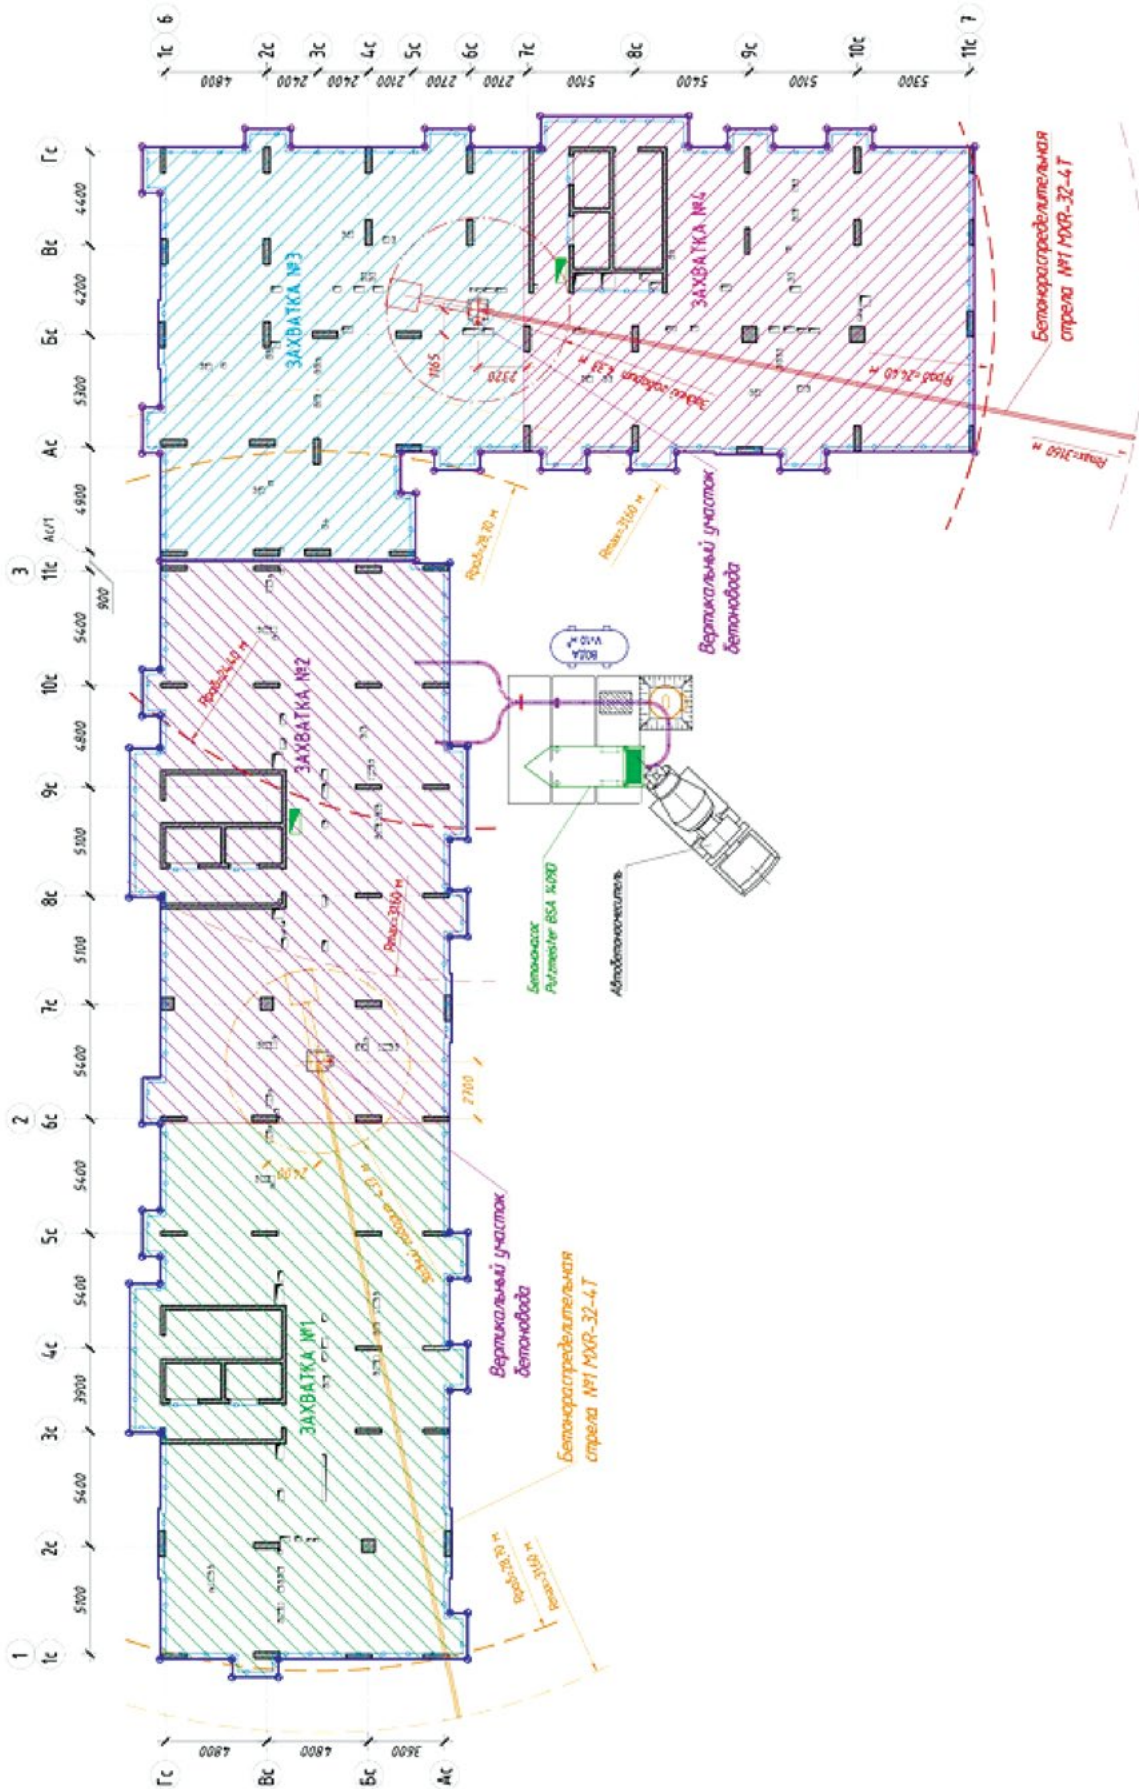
Схема размещения бетонораспределительных стрел на монтажном горизонте
